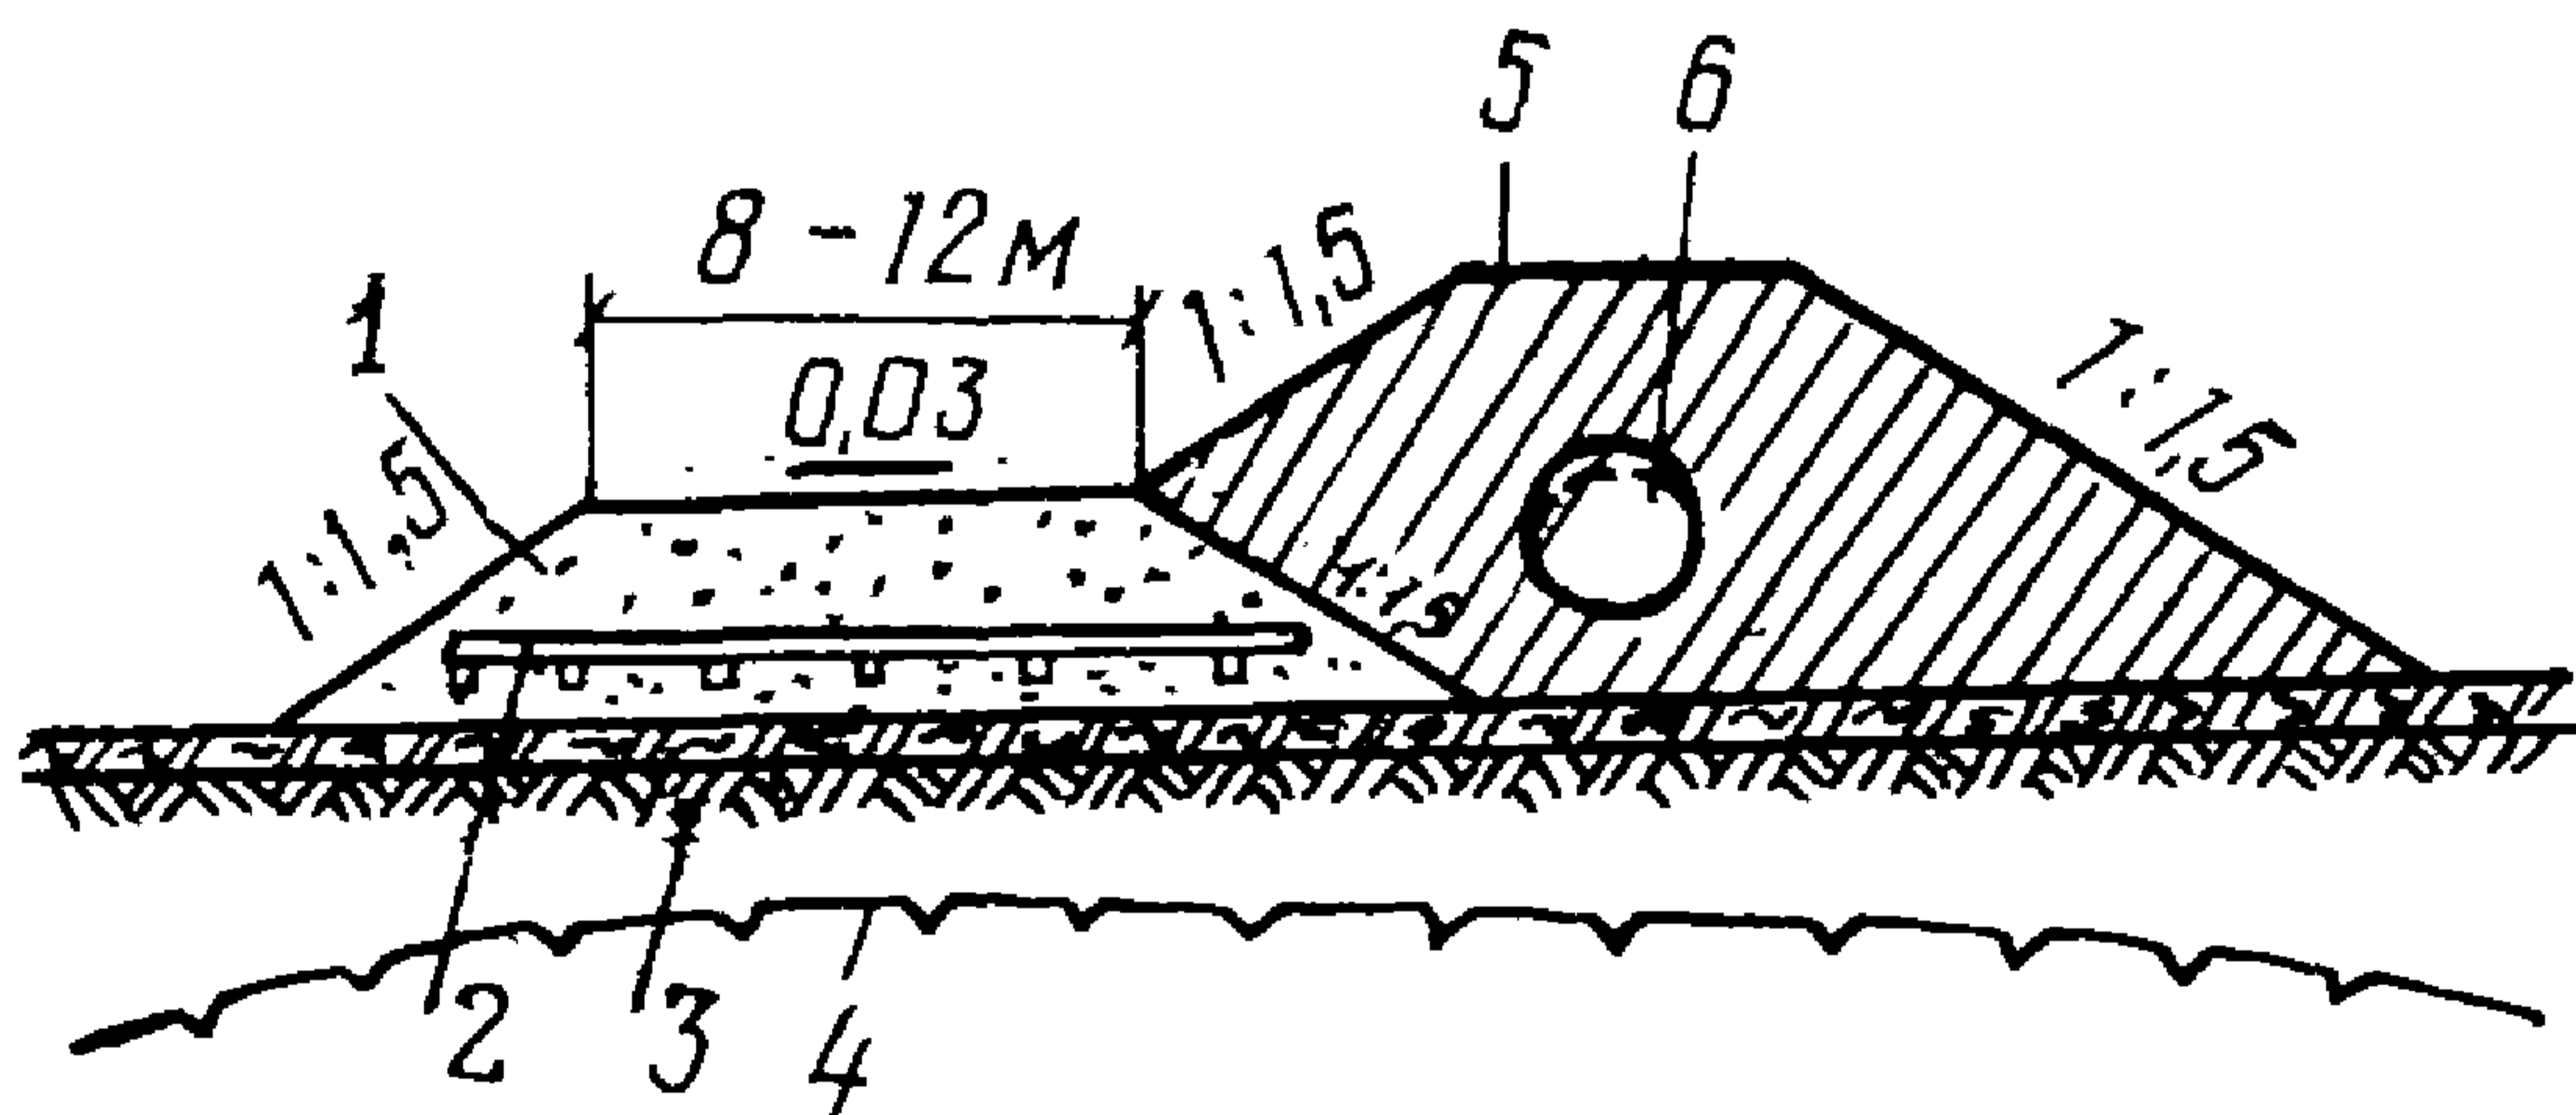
Поперечный профиль насыпи со сланевым настилом на участках четвертой группы ландшафтных комплексов при наземной прокладке трубопровода:
